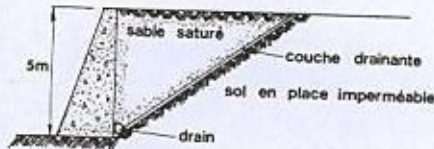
Mur avec remblai établi sur une couche drainante en pente
